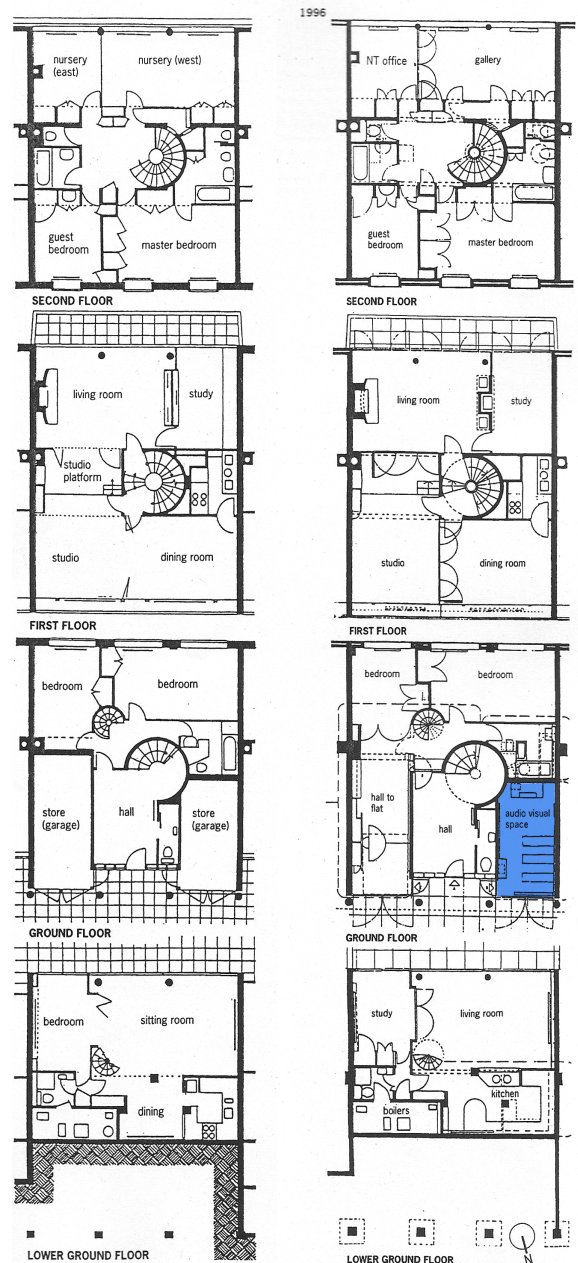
Planos de la residencia de Ernő Goldfinger antes y después de la intervención. En azul, el cine añadido en el antiguo garaje. Fotografías planos cortesía de Avanti Architects.
